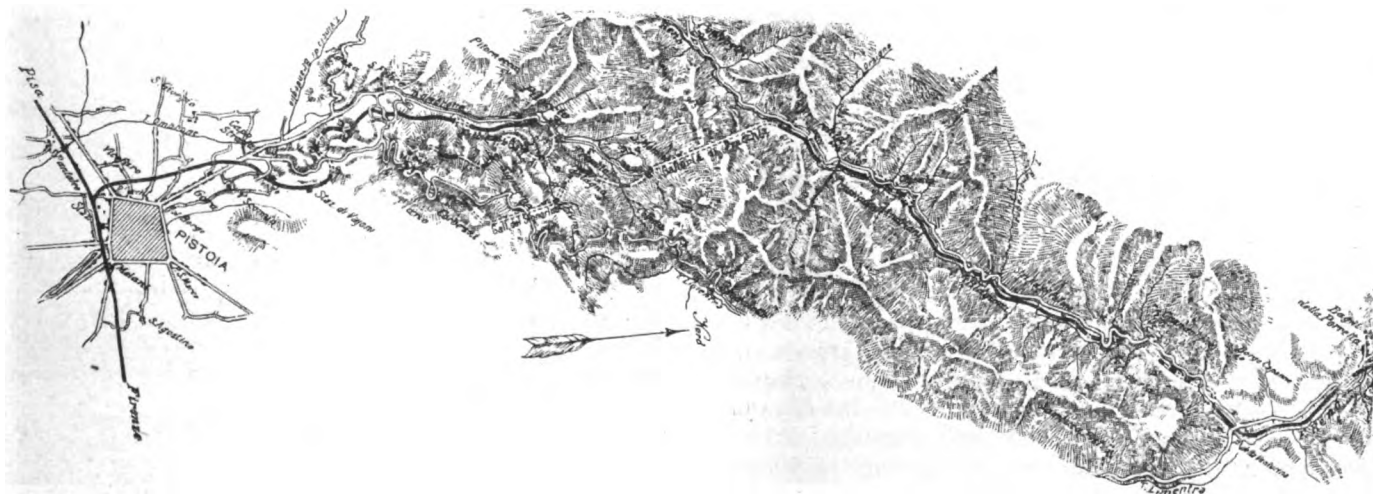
Planimetria del tronco Pistoia-Pracchia.
